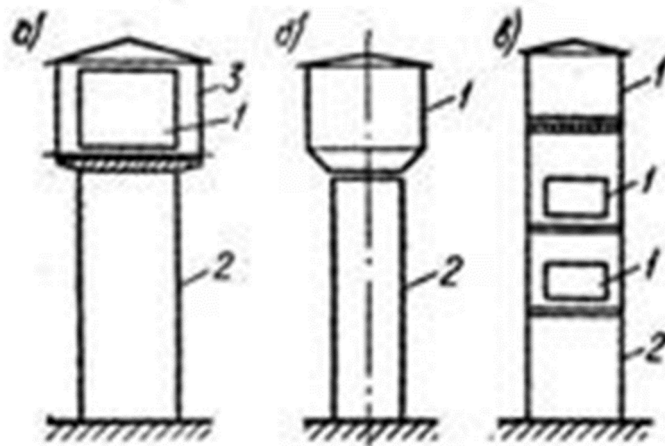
Типи водонапірних башт: а – шатрові; б – безшатрові; в – з декількома резервуарами; 1 – резервуар; 2 – опорні конструкції; 3 – шатер
